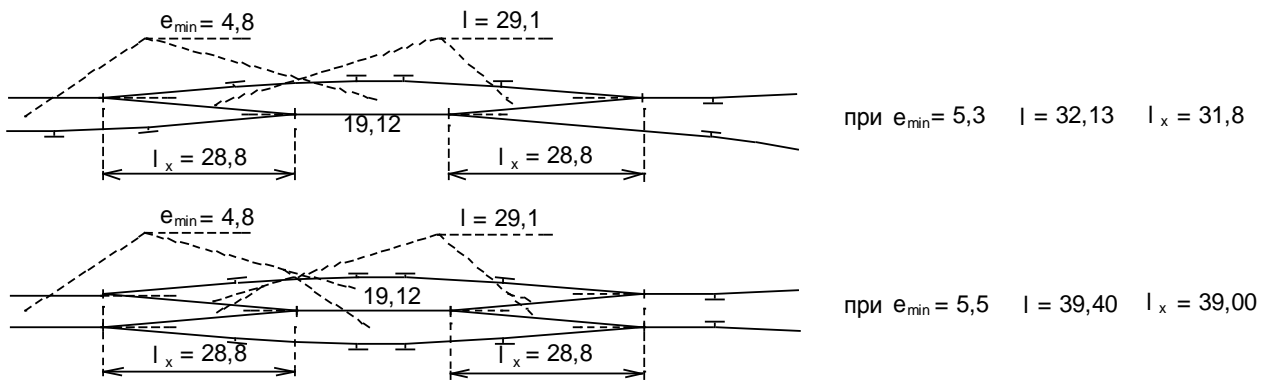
Схемы соединения двух спускных путей без перекрестного съезда
